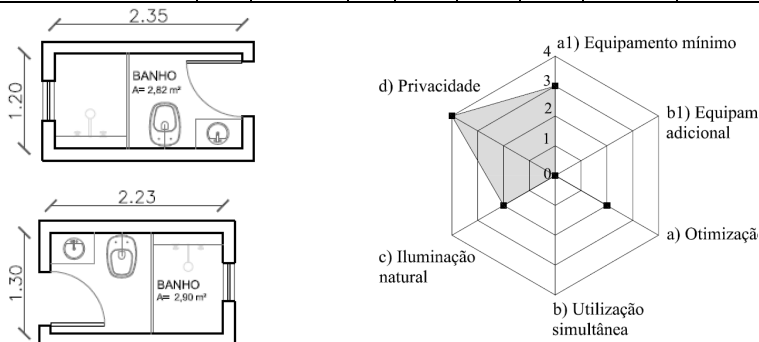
a) Planta baixa banheiro Tipo A. b) Planta baixa banheiro Tipo B. b) Modelo radar do banheiro Tipo A e Tipo B.
